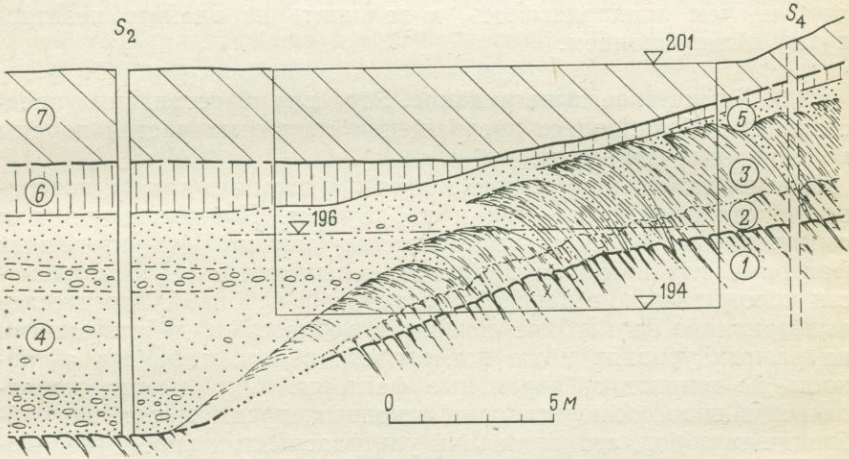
Разрез одного из строительных котлованов в Праге, вскрывающий нарушенные морозобойными трещинами сланцы.
